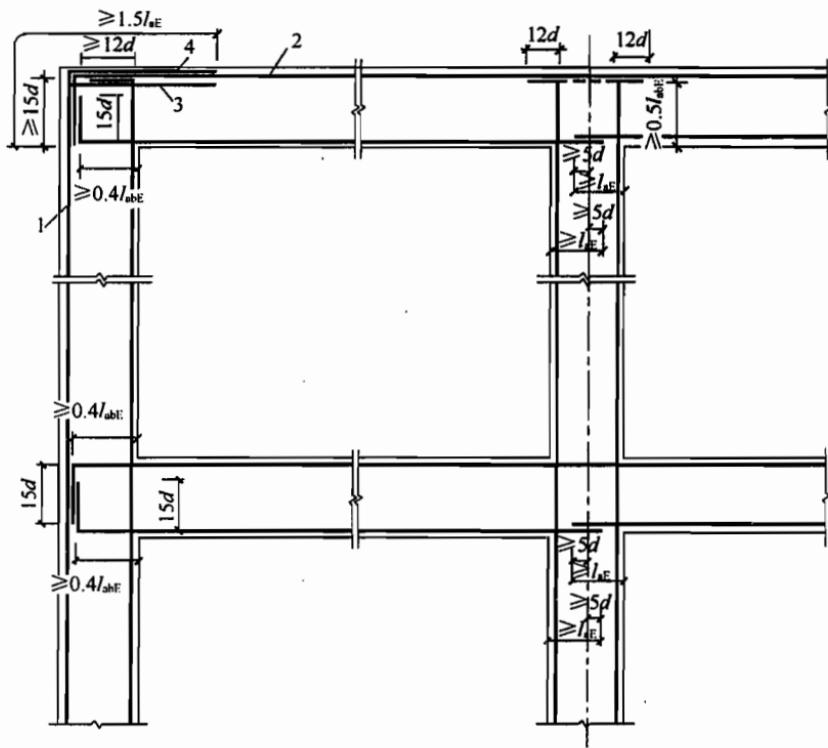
抗震设计时框架梁、柱纵向钢筋在节点区的锚固示意
